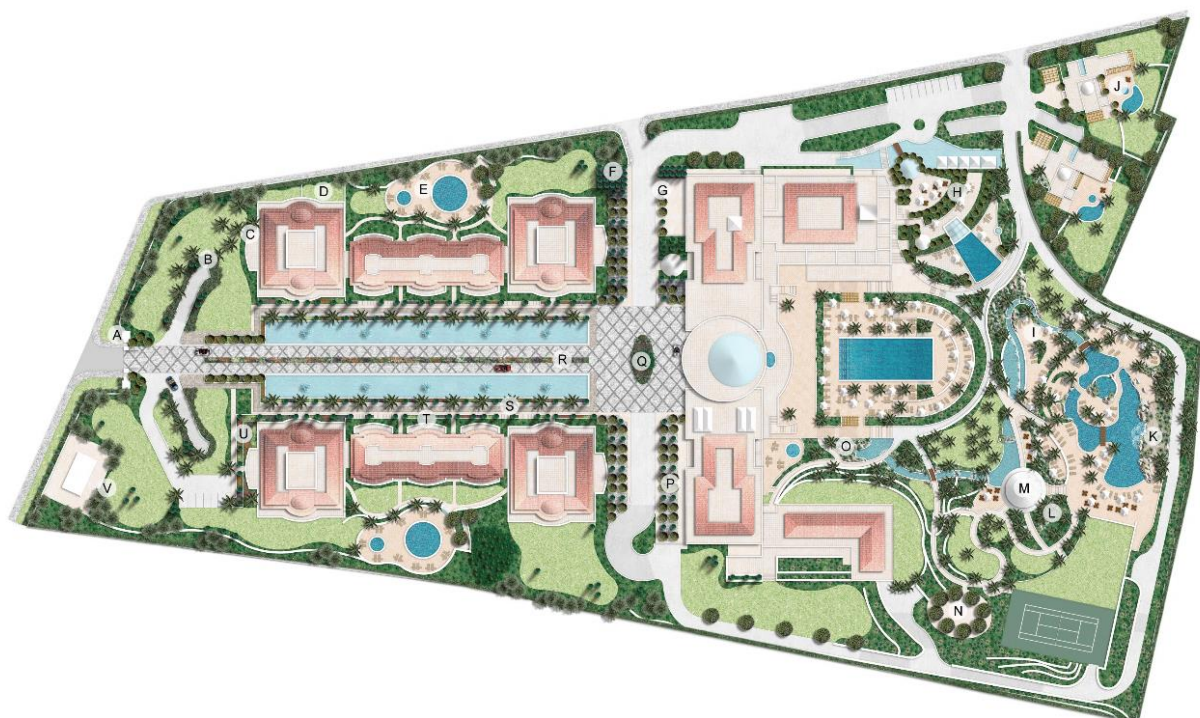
Plano geral da unidade hoteleira Conrad e área envolvente. Legenda: A - Plantação em ambos os lados da entrada para enaltecer a entrada principal; B - Área de relvado com Ciprestes; C - Área de plantio ao redor do limite da propriedade com *Lavandula*, *Gaura*, *Pistaccia* e *Teucrium*; D - Jardins privados; E - Piscina familiar com área de relvado; F - Ciprestes no jardim formal; G - Ciprestes em vasos; H - Jardim formal com laranjeiras e *Ficus* em bola; I - Cascata de água que liga a piscina familiar e a piscina infantil; J - Piscina e jacuzzi; K - Cascata de água como ponto focal interessante; L - Arbustos ornamentais em torno da área da casa de chá; M - Casa de chá; N - Clube infantil; O - Jardim tropical; P - Pomar com laranjeiras e ciprestes; Q - Rotunda em frente à entrada principal do hotel, plantada com *Phoenix roebeleni*, bola de *Cycas* e *Buxus*; R - Coberturas de solo floridas; S - Alinhamento de tamareiras; T - Alinhamento de ciprestes; U - Área de plantio; V - Grupos de oliveiras e ciprestes que ajudam na proteção da encosta. Fonte: Jardim Vista, 2011.
